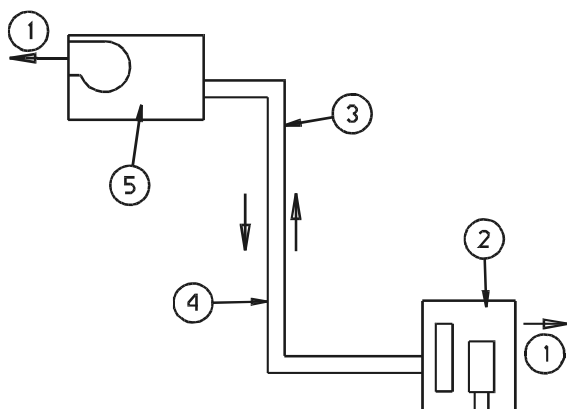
Монтаж трубопроводов хладагента (наружный блок расположен выше внутреннего)
